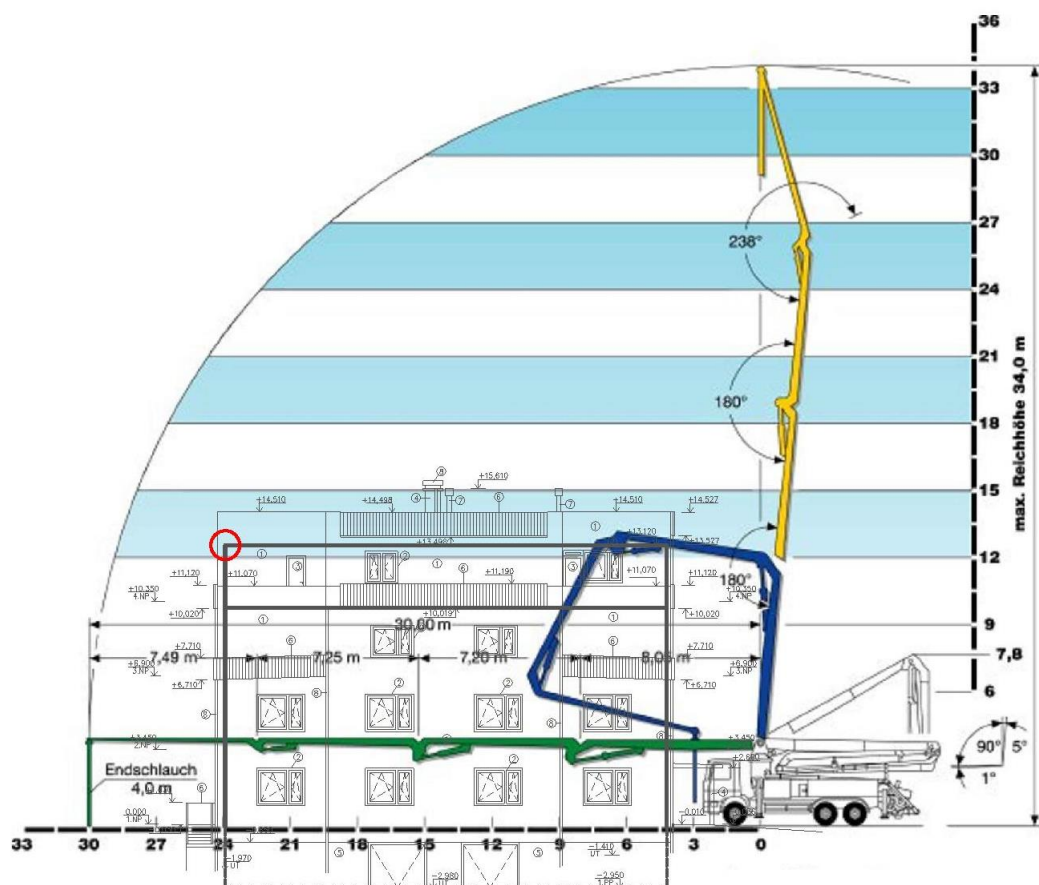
Autočerpadlo SCHWING S 34 X [5]
